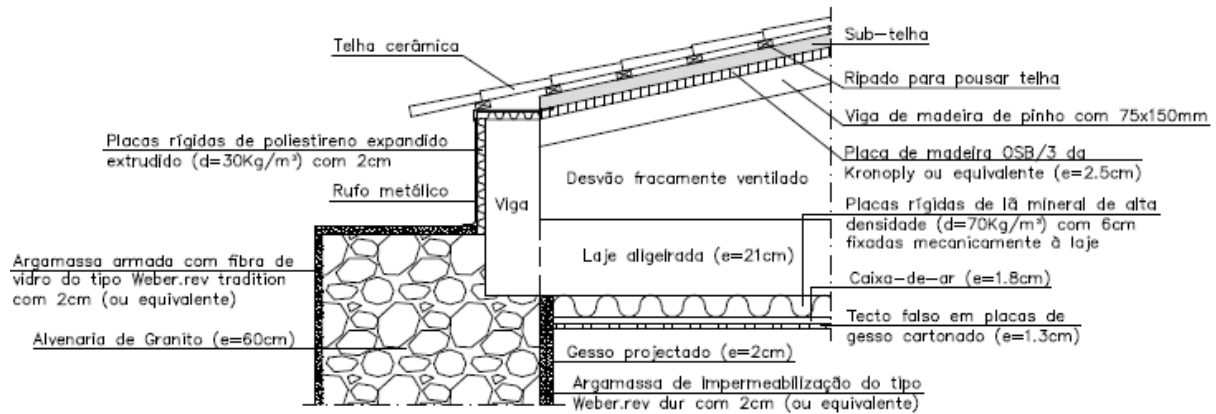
Pormenor de ligação da fachada com laje da cobertura (Projeto de CT)
